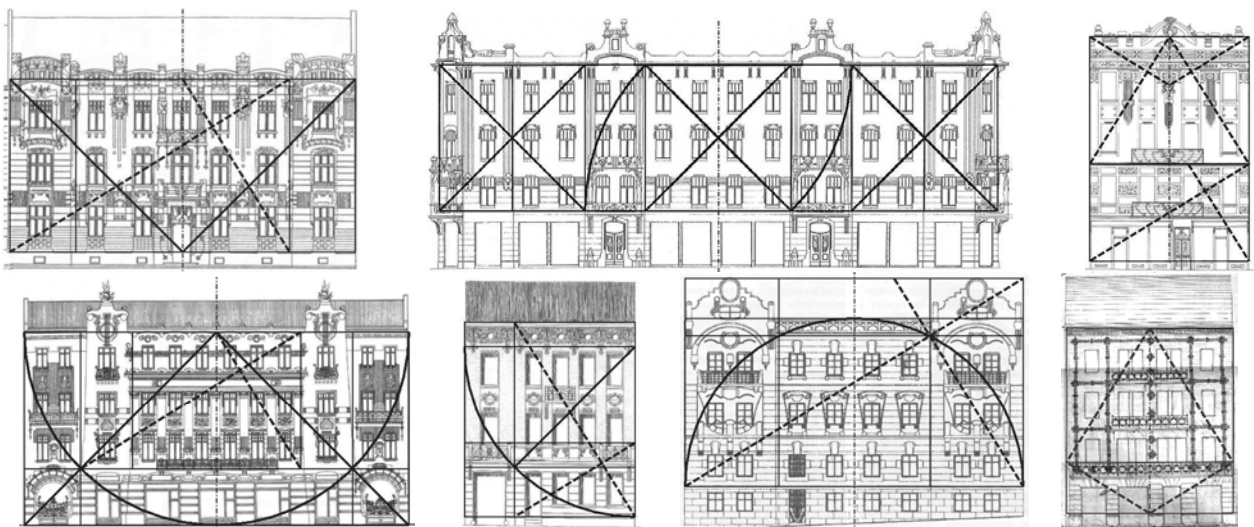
Схеми пропорціювання фасадів у стилі декоративної сецесії частина фасаду (без I поверху)
